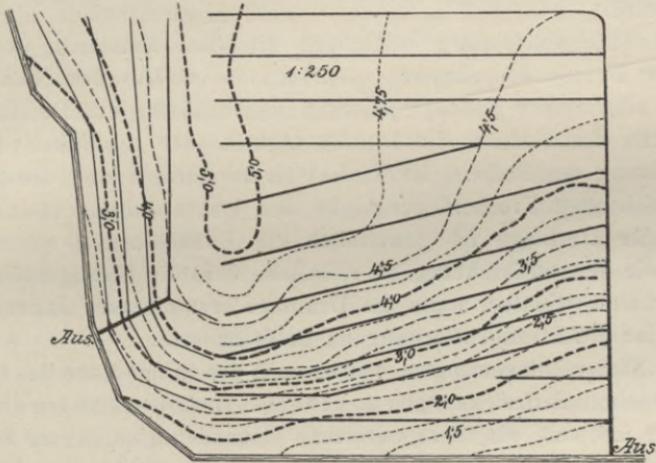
Querdrainage mit Übergang in Längsdrainage.
